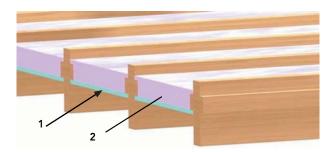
77: Colocación de aislación termo-acústica, entre el listoneado de cielo sobre la plancha de yeso cartón para luego colocar el tablero estructural, arriostrando la estructura de plataforma del entrepiso.
